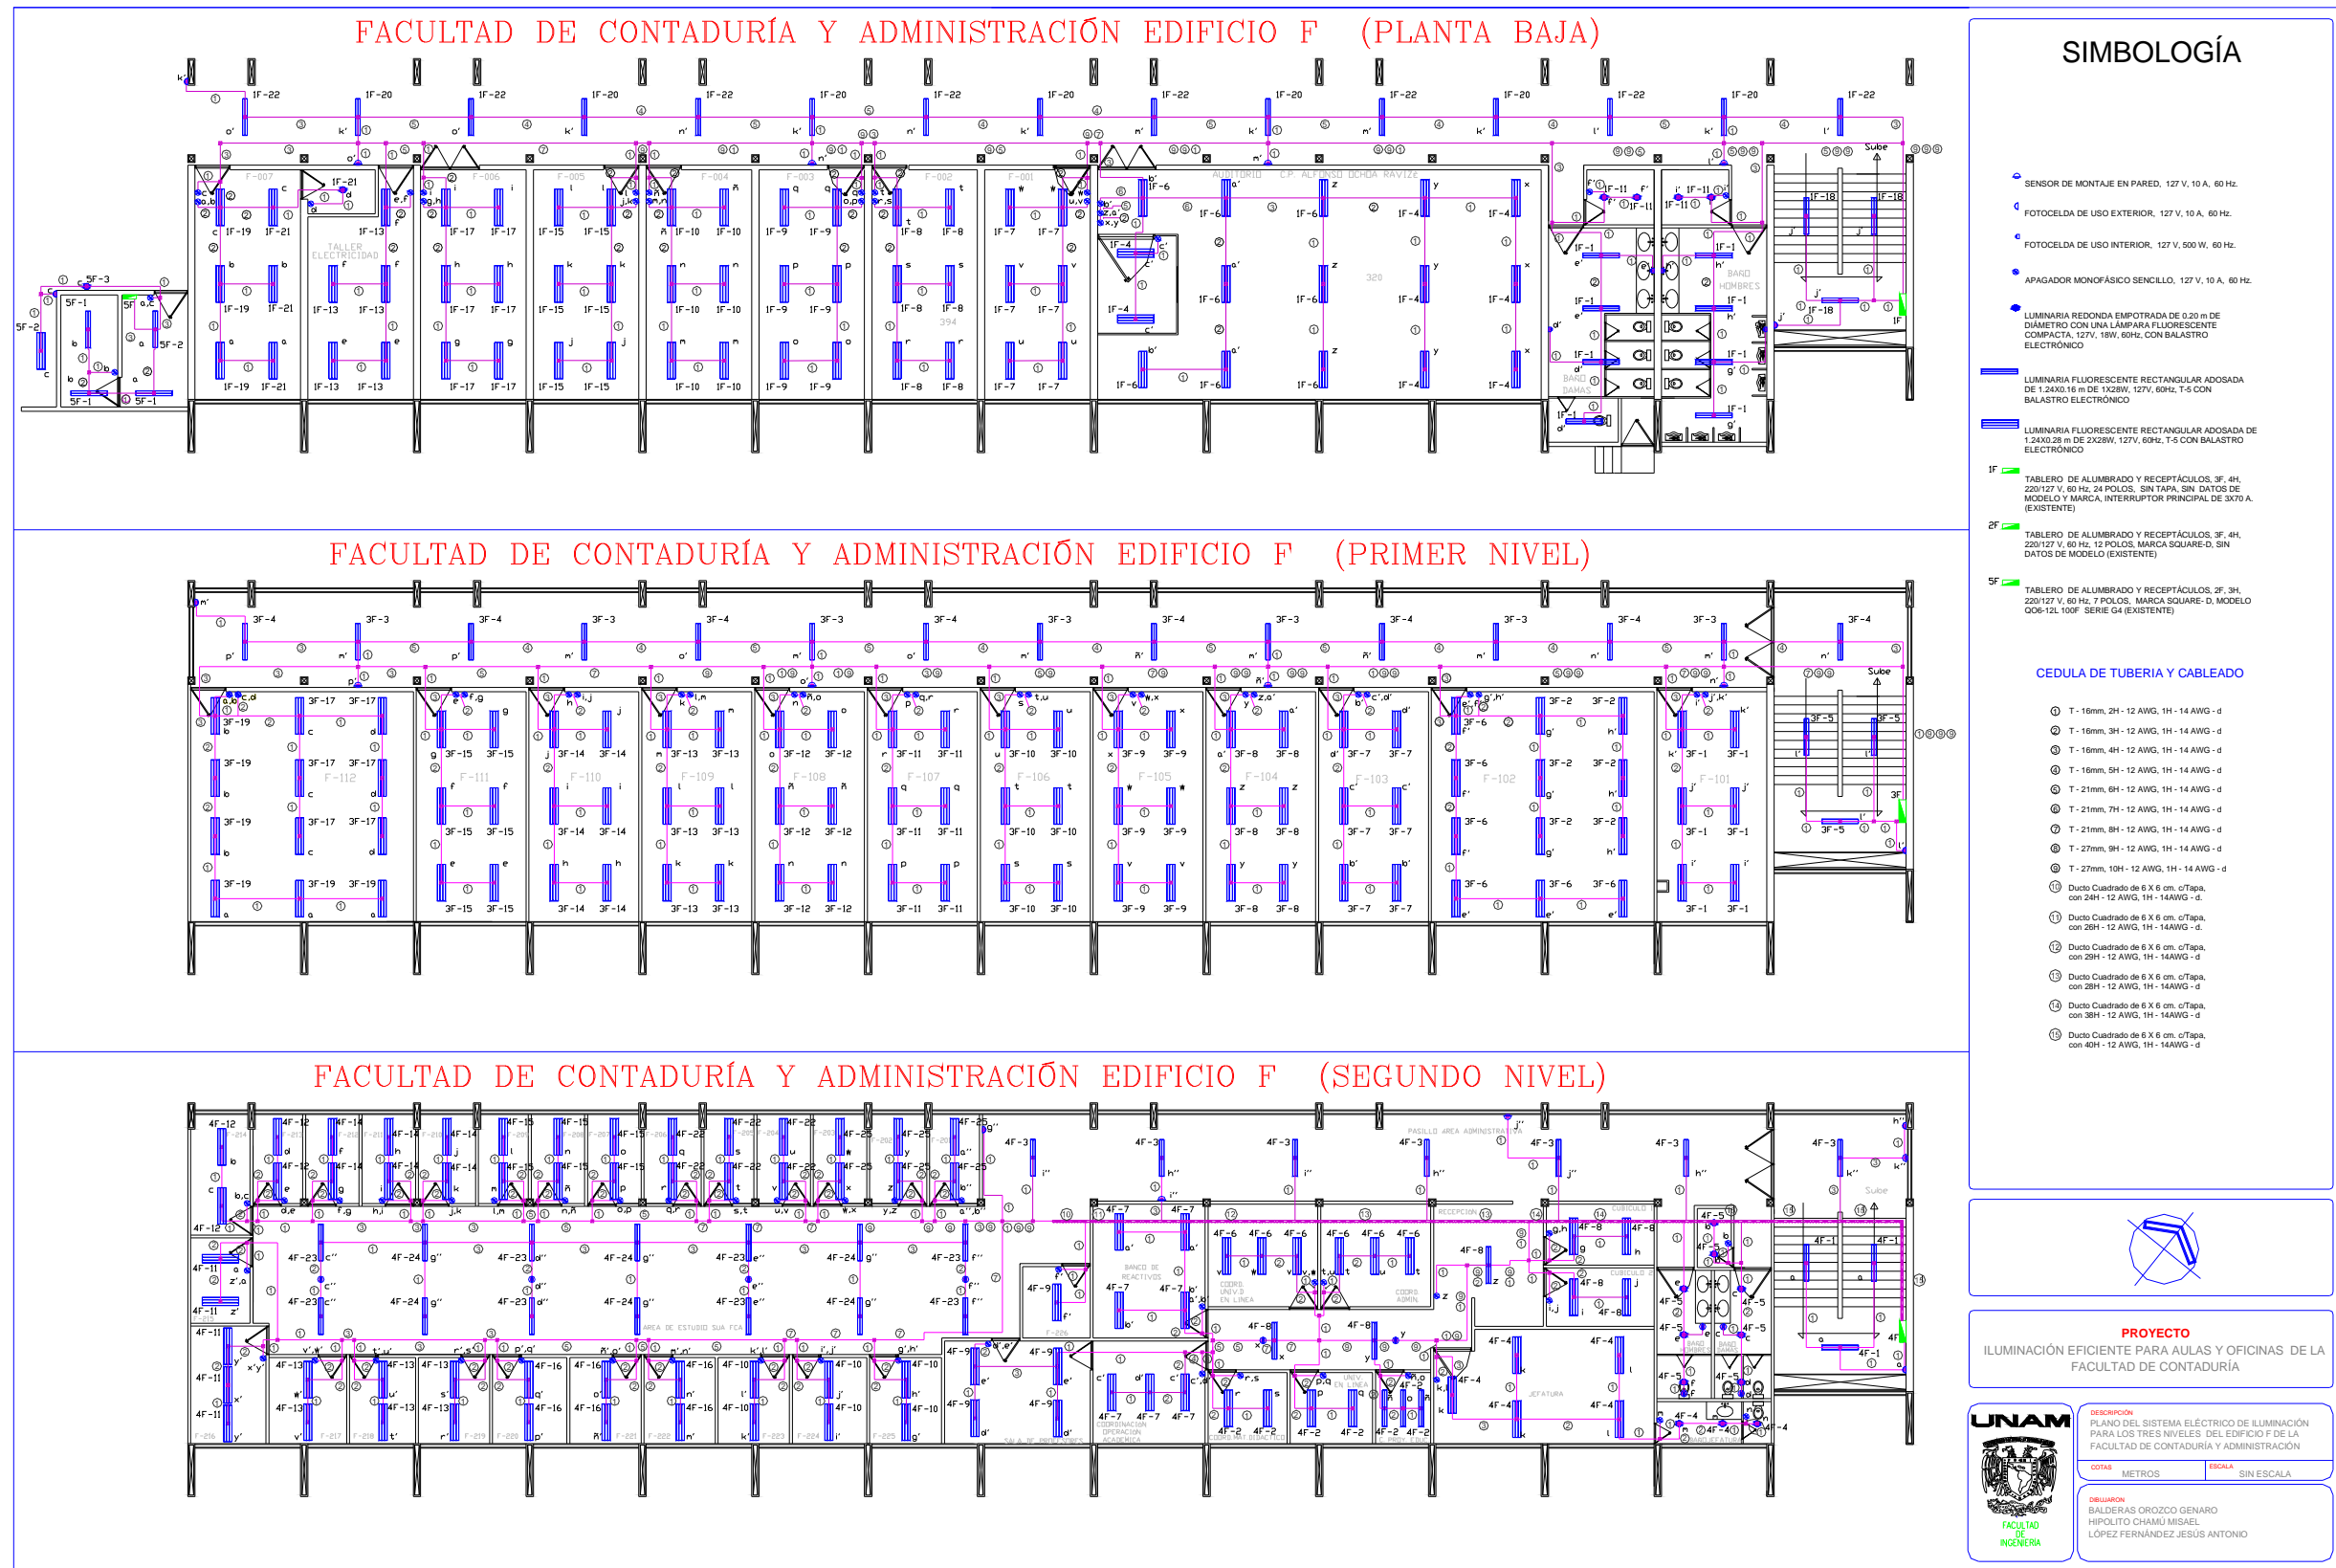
Planos de la instalación eléctrica de iluminación para los tres niveles del Edificio F.
